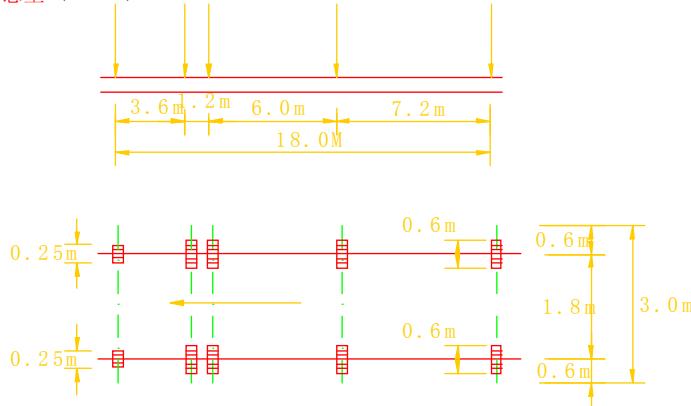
城—A 级标准车辆纵、平面布置
